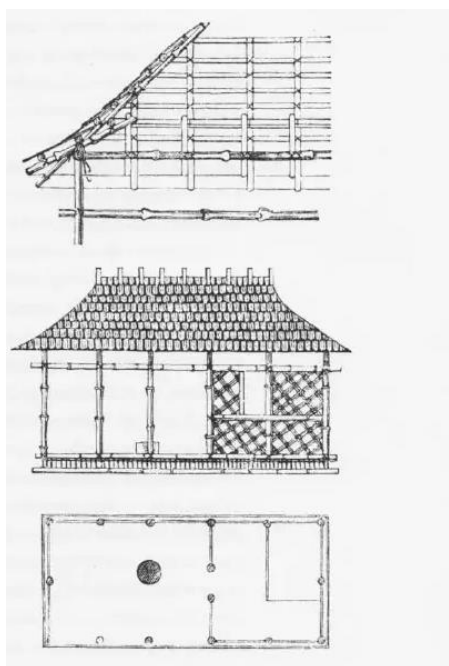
Cabana caribenha. Planta, corte e detalhe - Grande Exposição de 1851.
